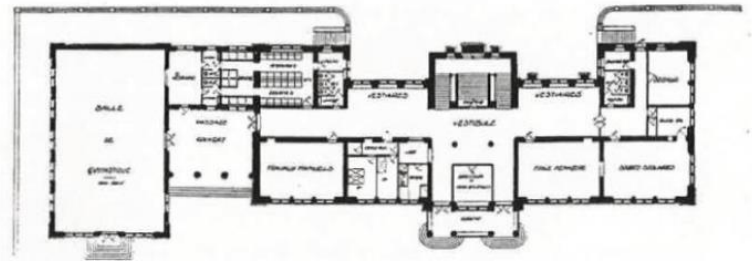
Vue et plan d'une école style Heimatstil en 1907 (Source : Martin A, 2014)
